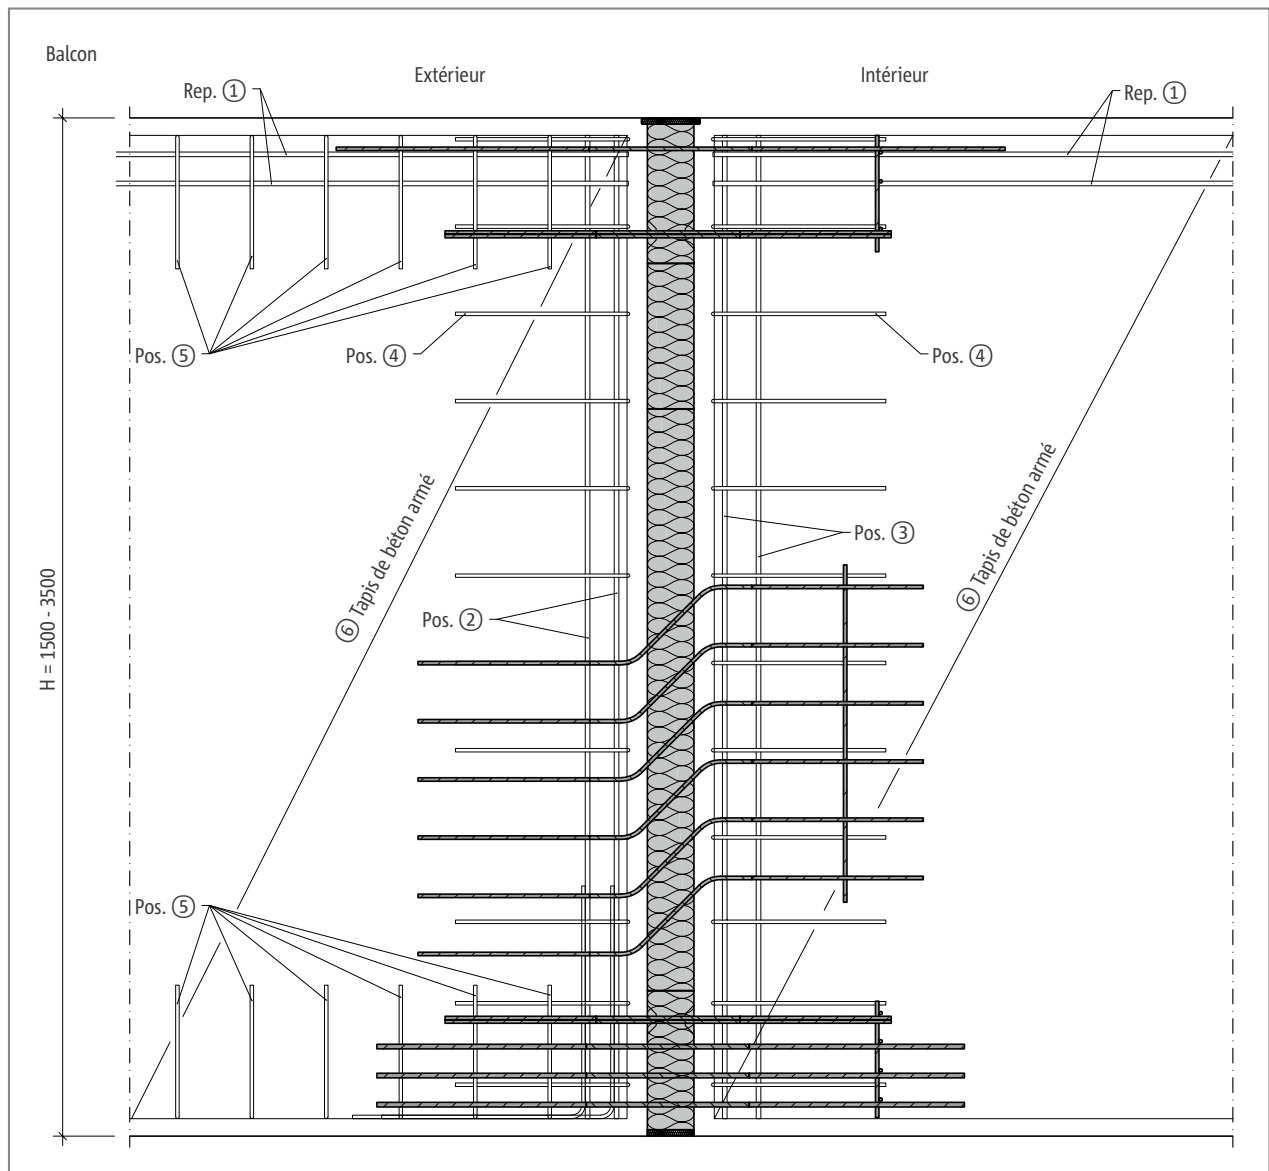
Schöck Isokorb® T Type W : Renforcement sur site (coupe)
